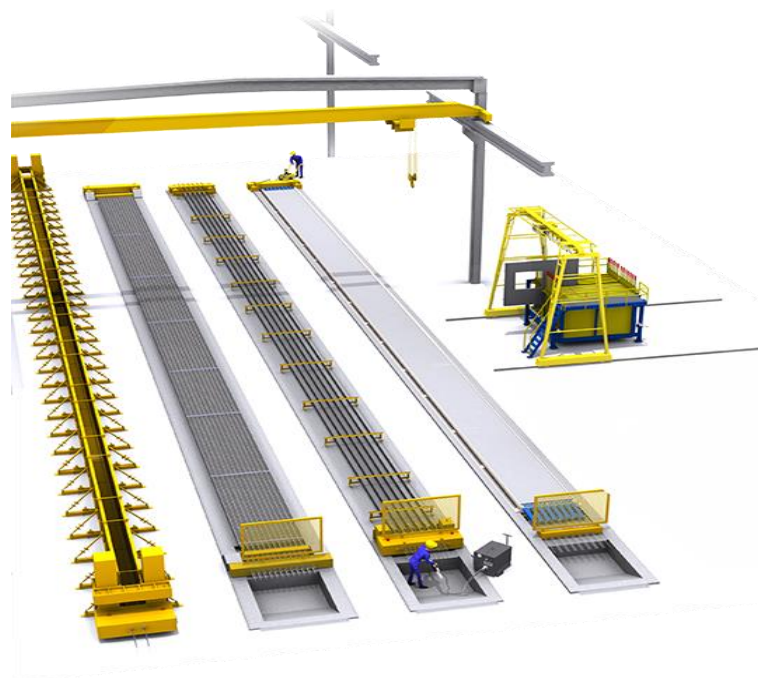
Etapas de execução de vigas calhas e detalhe da ancoragem da armadura
